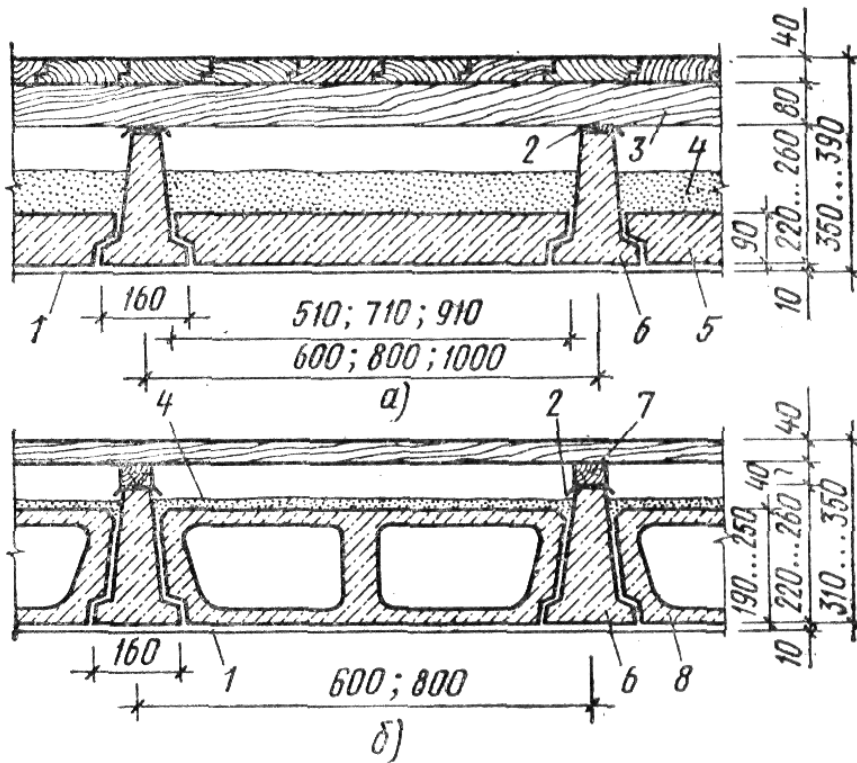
Сборное железобетонное балочное перекрытие:
